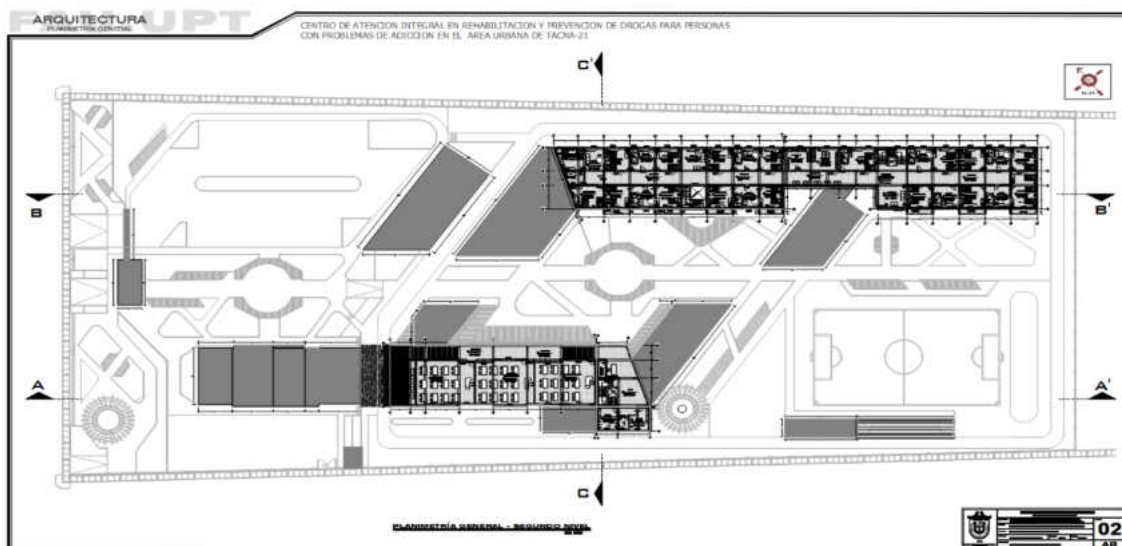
Planimetría general 2do piso, fuente elaboración propia.
